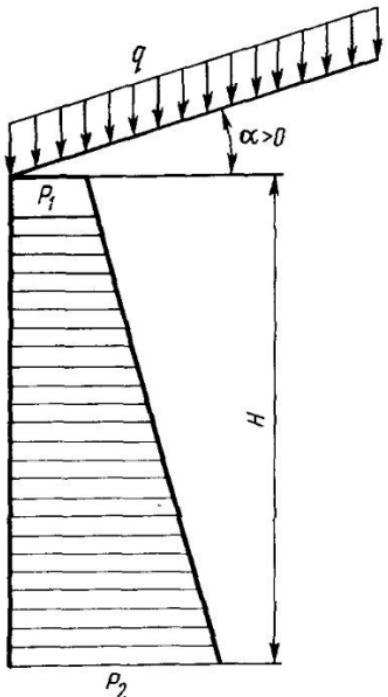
Схема для определения активного давления песка или супеси на стенку ограждения в случае, если поверхность грунта ограничена плоскостью и на ней равномерно распределена нагрузка
